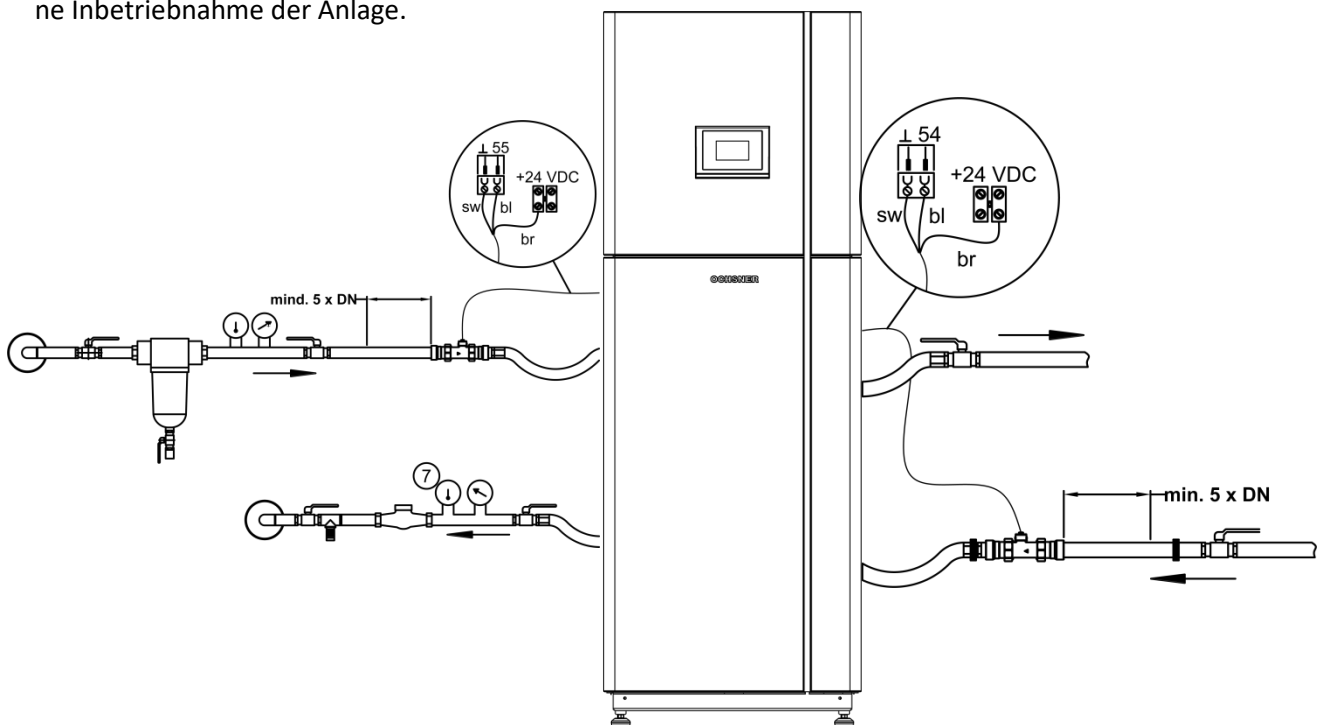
Einbau Durchflusssensor WQA – Grundwasser und WNA
